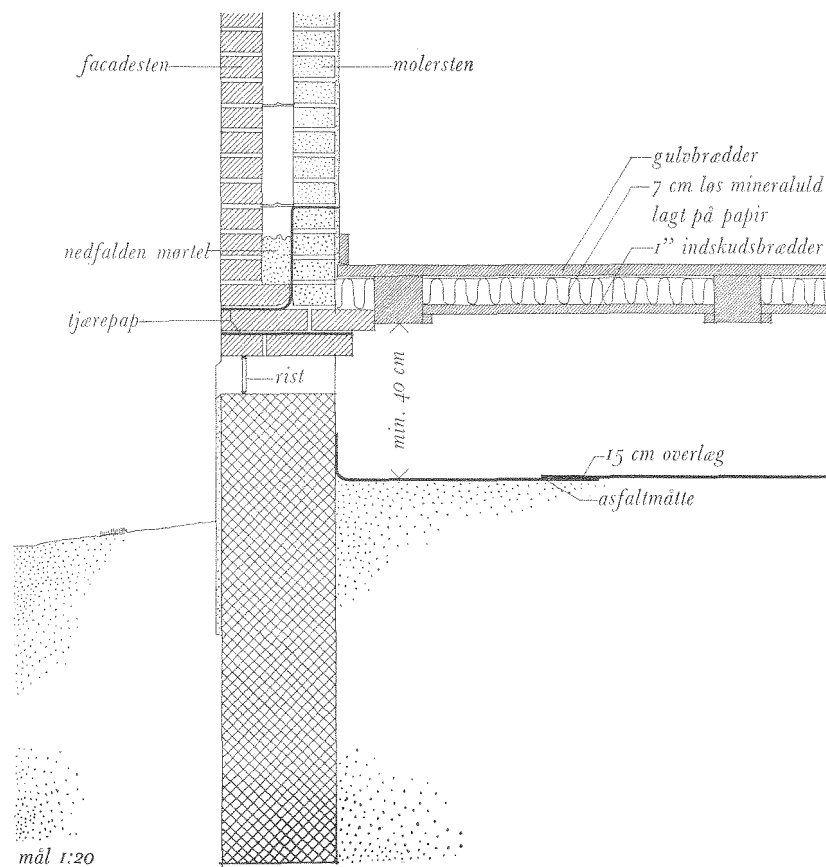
FUGTISOLERING AF KRYBERUM. Almindeligvis afdækkes med et lag beton; denne beton bør være god og tæt; et tyndt lag god beton er bedre end et tykt lag dårlig beton. Endnu bedre er det at afdække med en asfaltmätte. Asfaltmätten skal være armeret med imprægneret jutevæv eller bedre et væv af uforgængeligt materiale og må ikke
